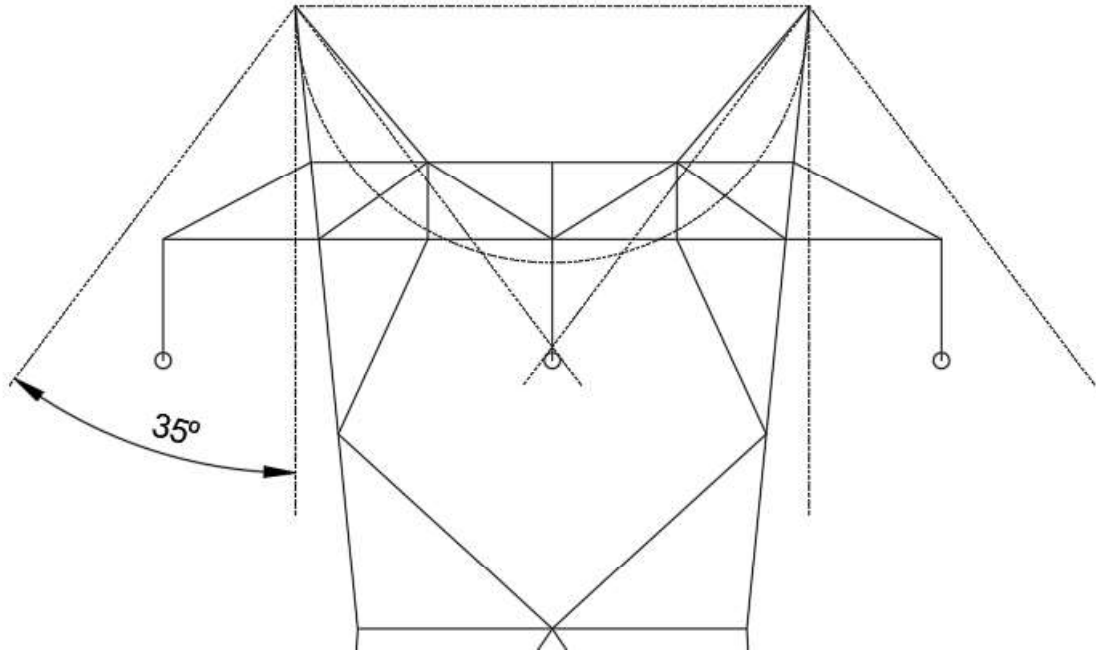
Zona de apantallamiento efectiva de los cables de guarda.
